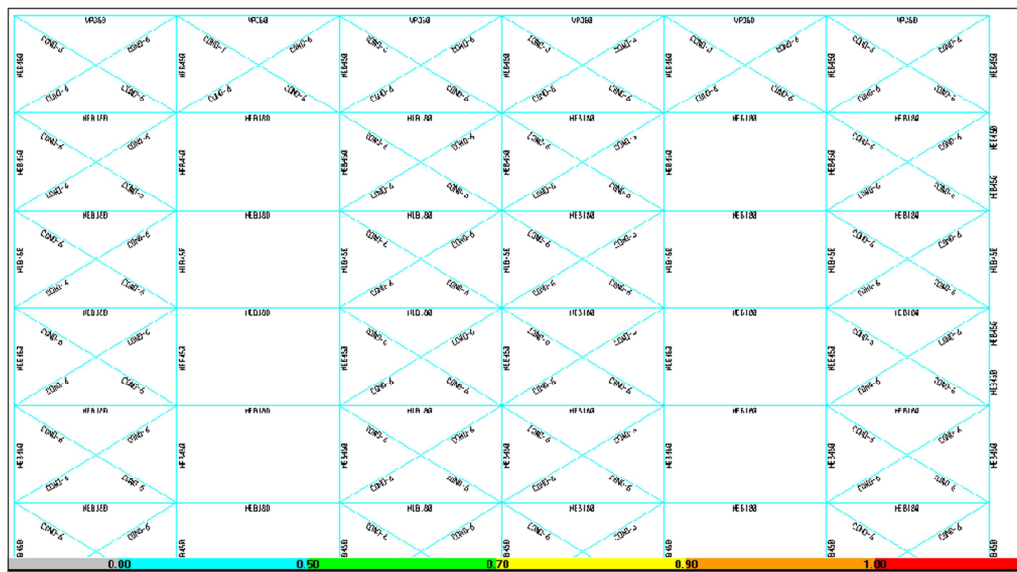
Verificación de vigas y columnas principales y vigas secundarias.
